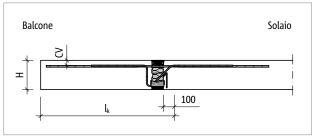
Schöck Isokorb® T tipo KL-M8 – M12: sistema statico
